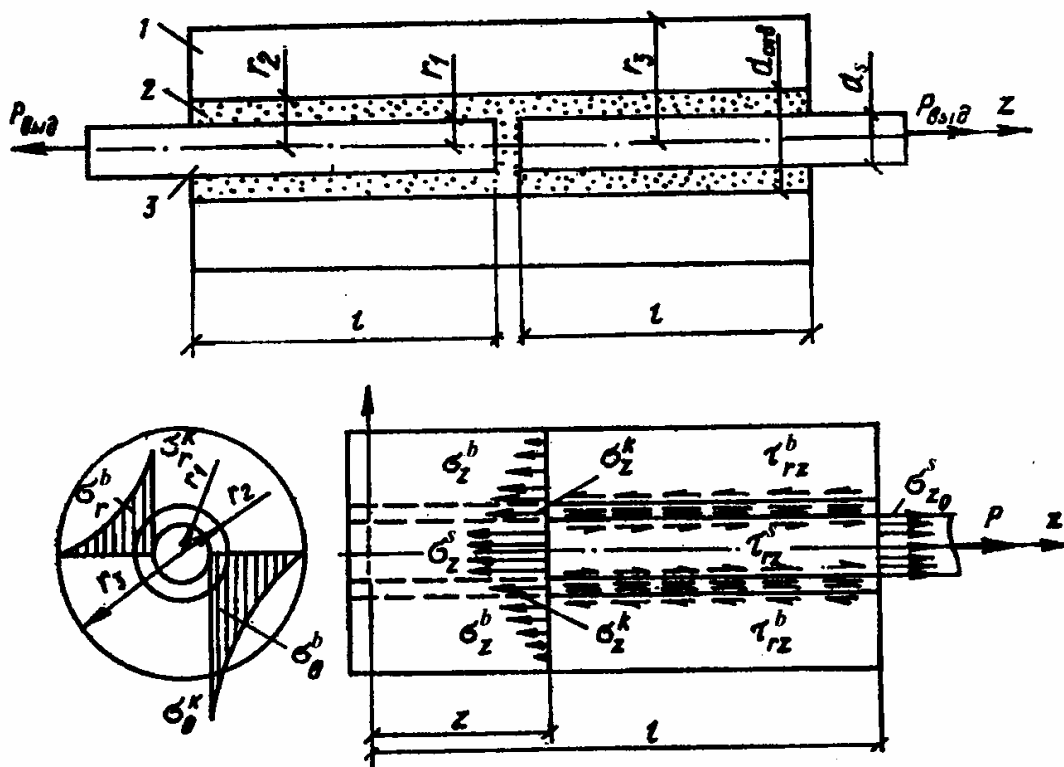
Розрахункова схема анкерного з'єднання на клеях:
